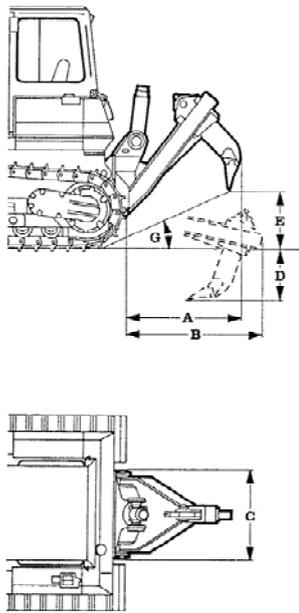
Arbeitsweise und Einbauschemata einer Planierraupe
